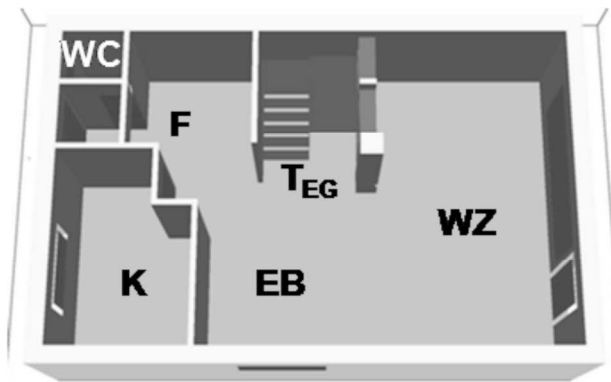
Grundriss des Erdgeschosses mit Küche (K), Flur (F), Gästetoilette (WC), Essbereich (EB), Wohnzimmer (WZ) und Treppenaufgang (T_{EG}).
